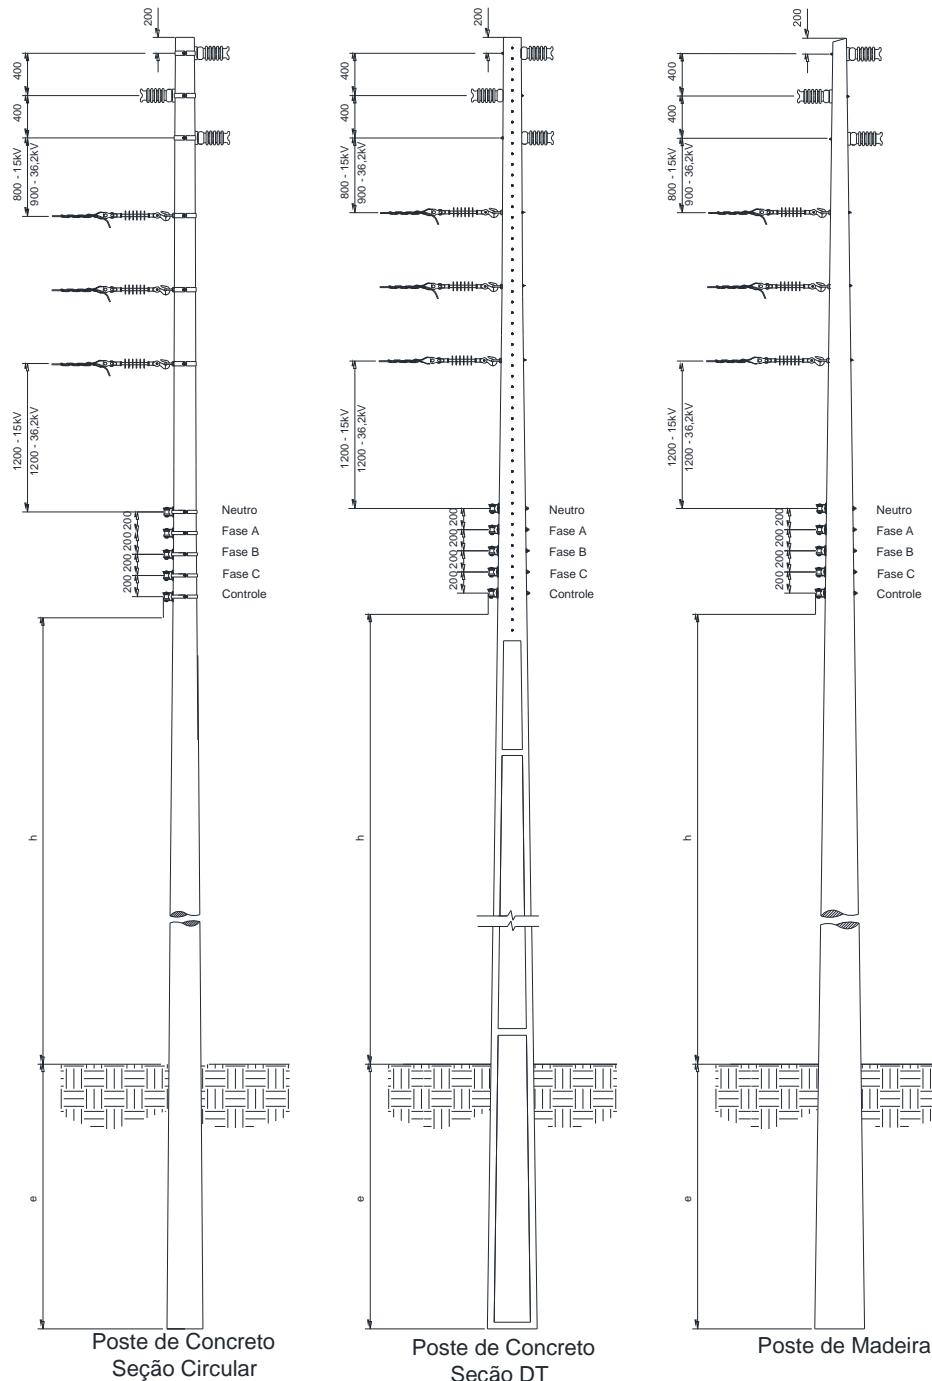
Afastamentos mínimos – Estruturas pilar trifásicas tangentes com derivação pilar
